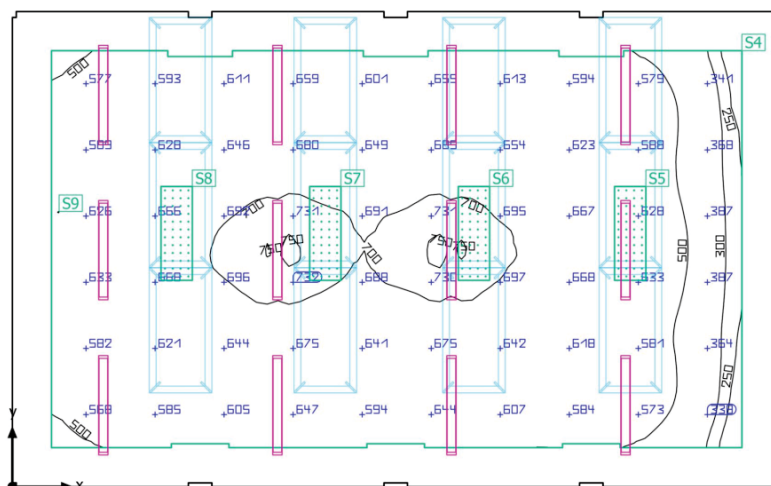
Layout da iluminação proposta para as salas de aula noturna, incluindo os planos de cálculo luminotécnico.
